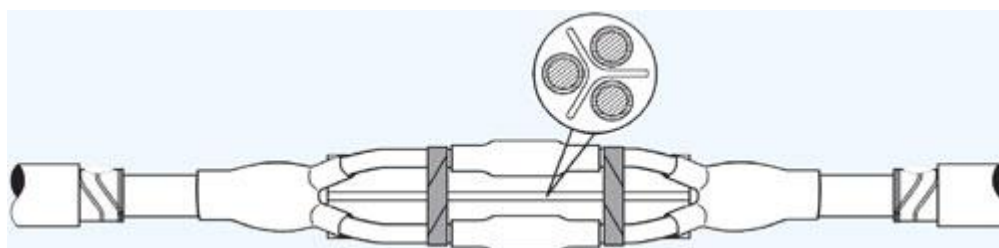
Установка распорки между жилами и стяжка жил бандажами из стеклотенты
